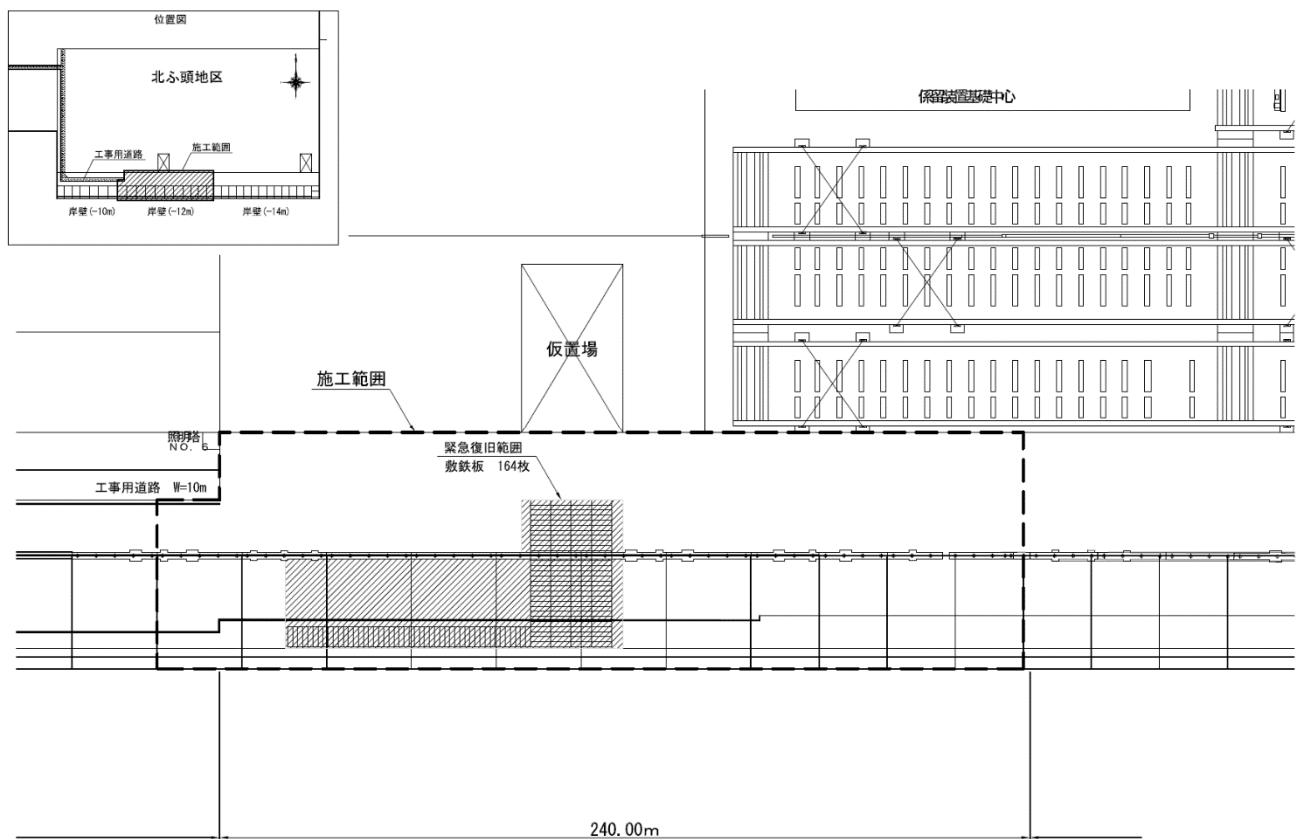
No.5 常陸那珂港区\_北ふ頭岸壁(-12m)の平面図 (被災後)
